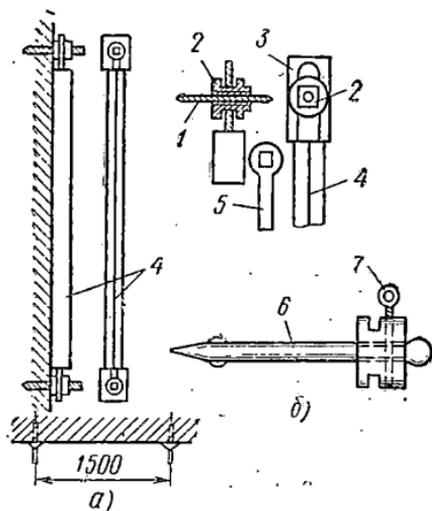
Инвентарные металлические маяки конструкции А. М. Шепелева:
